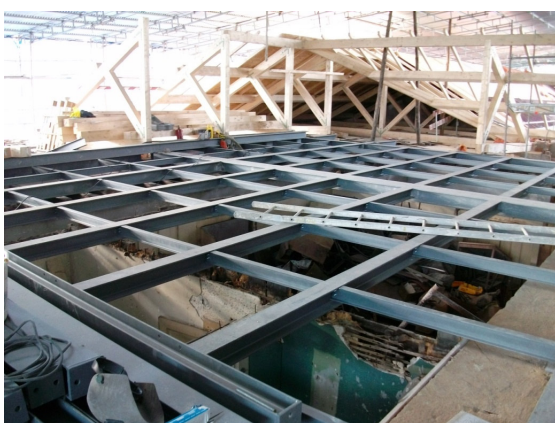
Montagem da estrutura metálica do terraço técnico.
